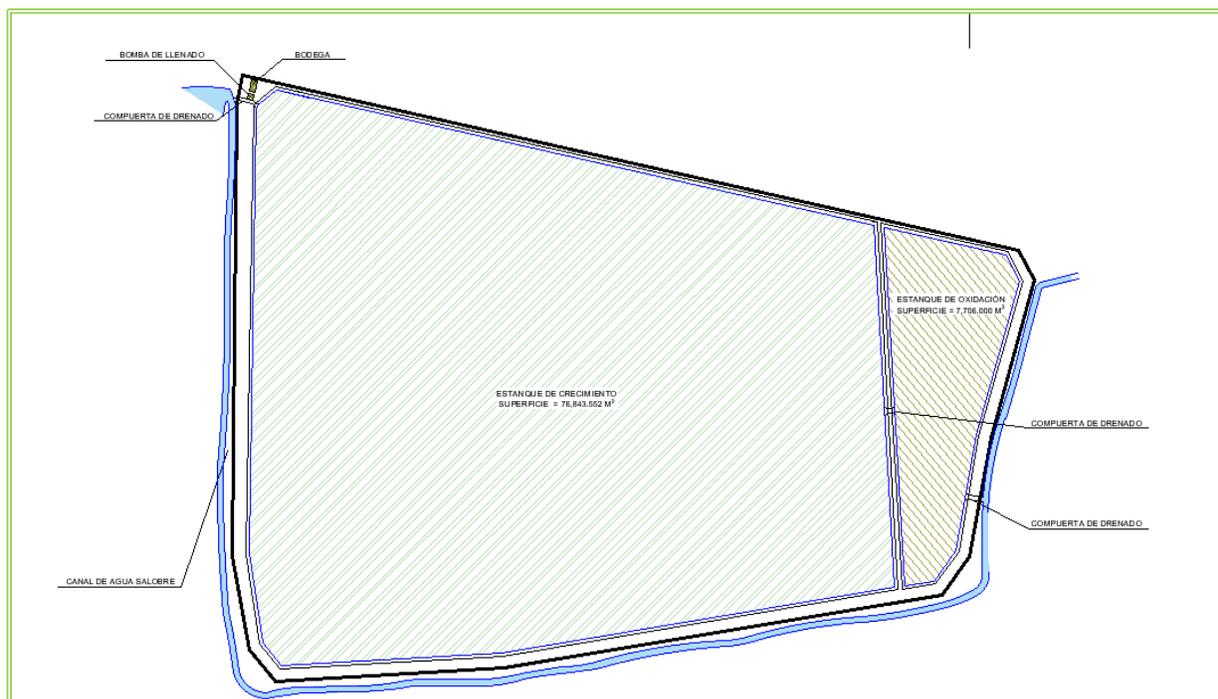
Plano conjunto del proyecto Granja Camaronera Isabel
